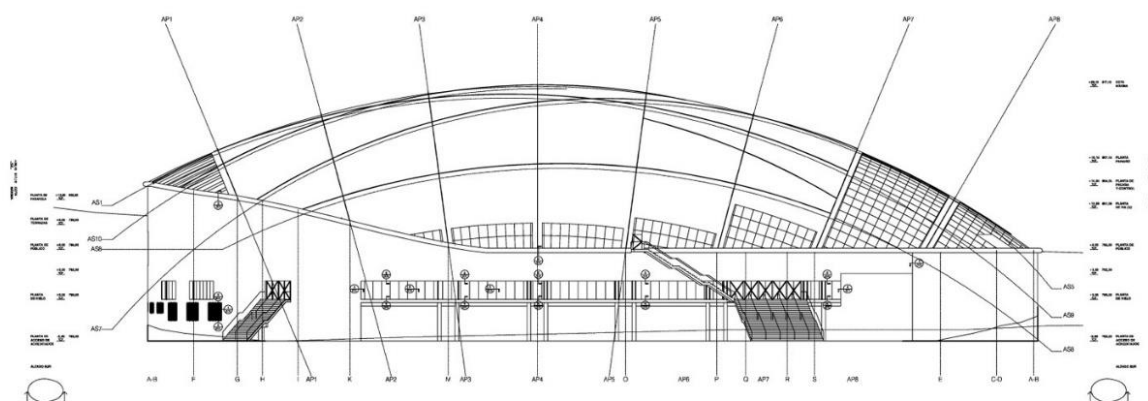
Повздовжній розріз, арх. Coll-Barreu Arquitectos: Coll-Barreu Arquitectos – Juan Coll-Barreu & Daniel Gutiérrez Zarza [4]
